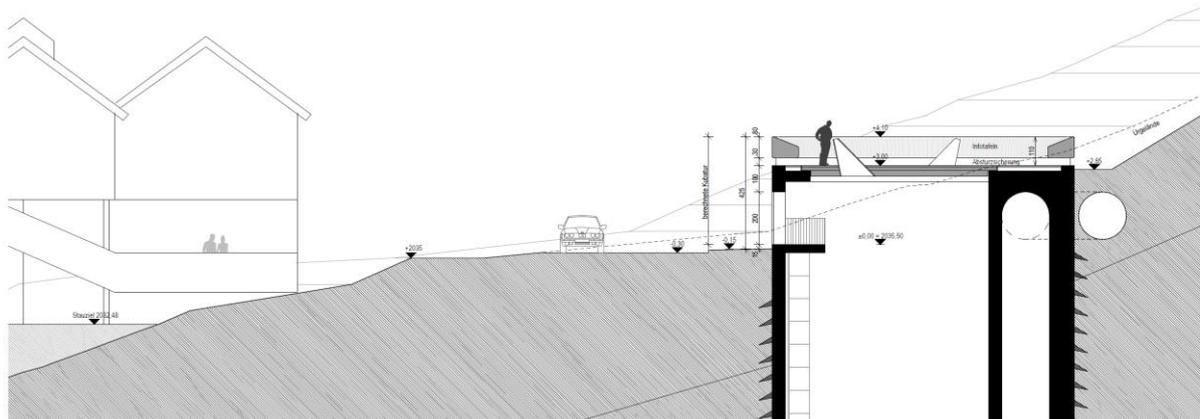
Schnitt Schützenschacht Silvretta (siehe Beilage 4.3)
